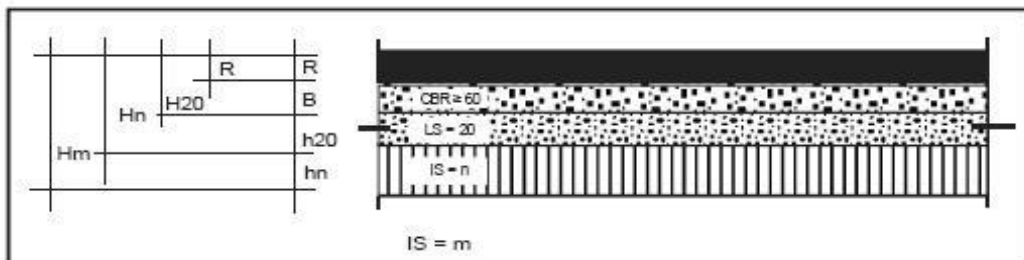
Ábaco de Dimensionamento de Pavimentos (Fonte: Manual de Dimensionamento de Pavimentos do DNIT - 2006)
